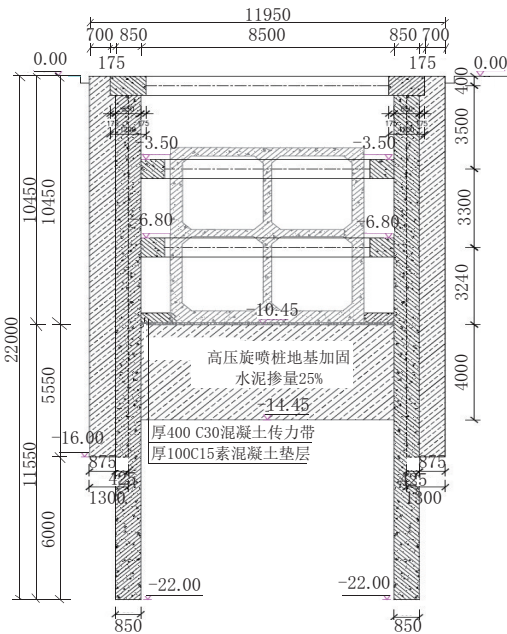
叠层布置方案基坑标准段围护剖面图(单位:mm)
